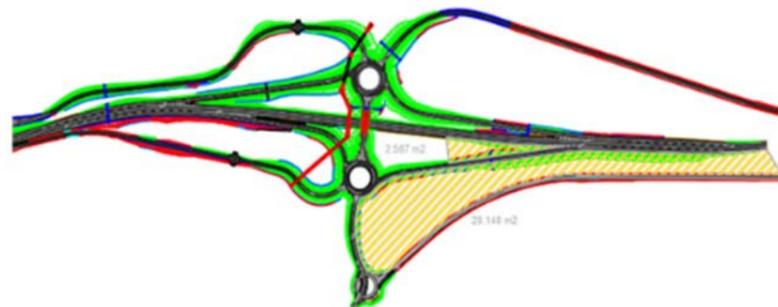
Detalle en Planta de Zona Inundable. Zona B
